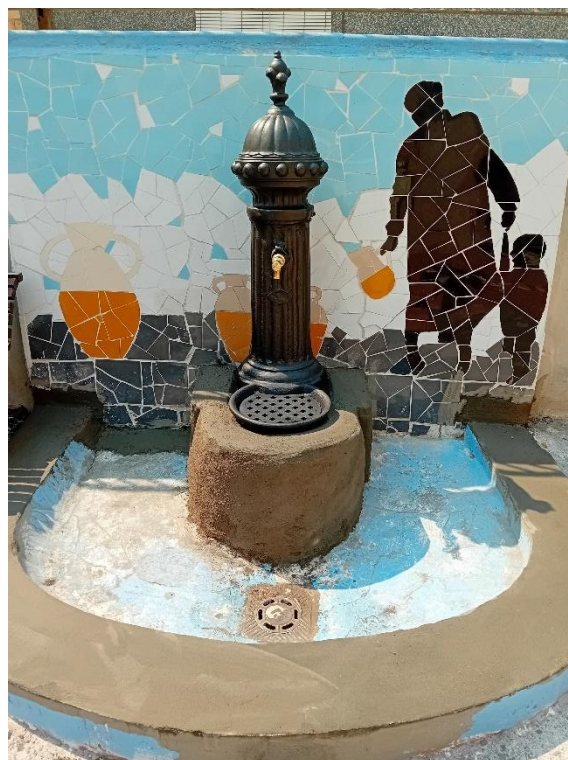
; reconstrucción y rebajado del pedestal y explanada.
